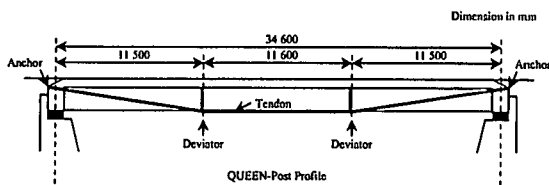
施工事例 (一般道路橋への適用) ⁶⁾
